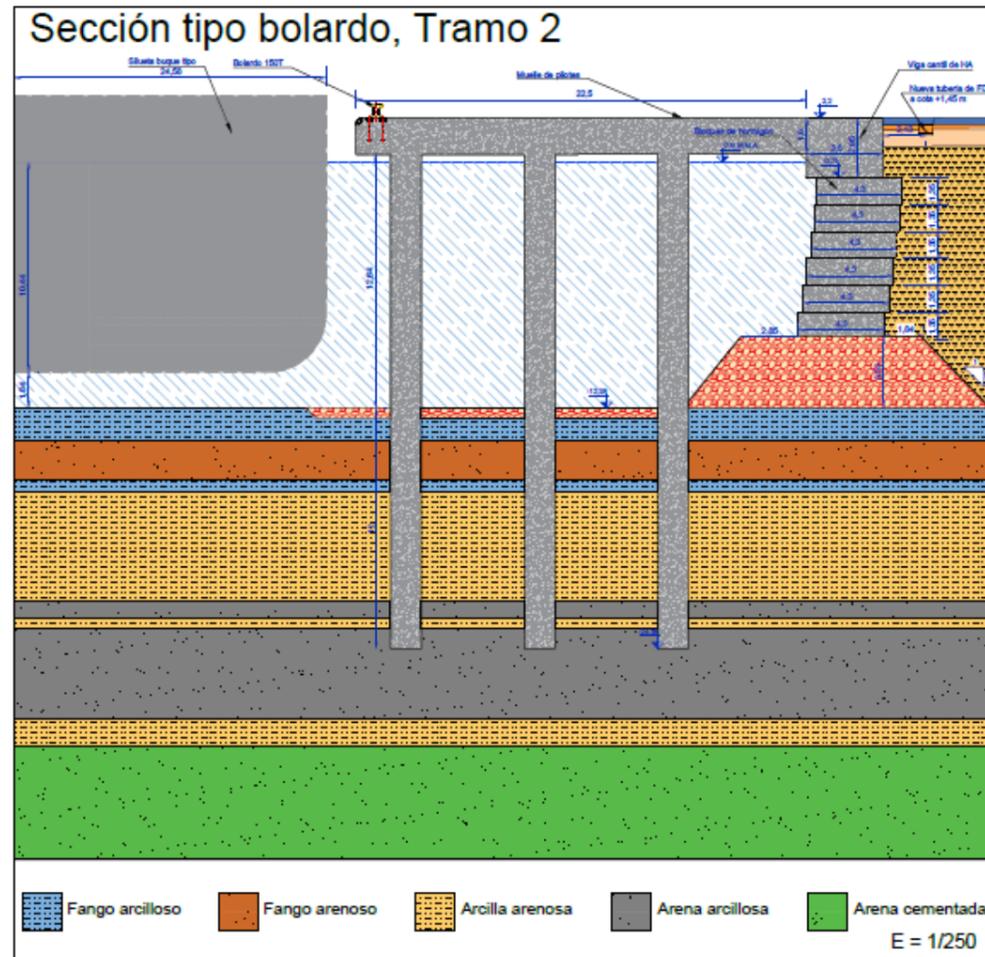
Sección tipo Tramo 2 de la solución proyectada.
